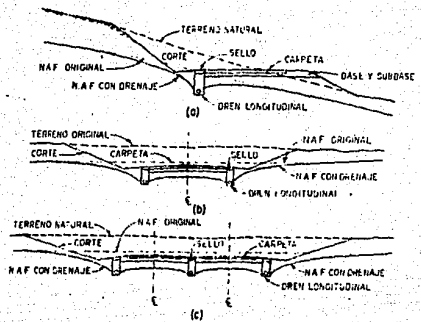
Caso de uso de drenes longitudinales de zanja para abate el S. A. P.
